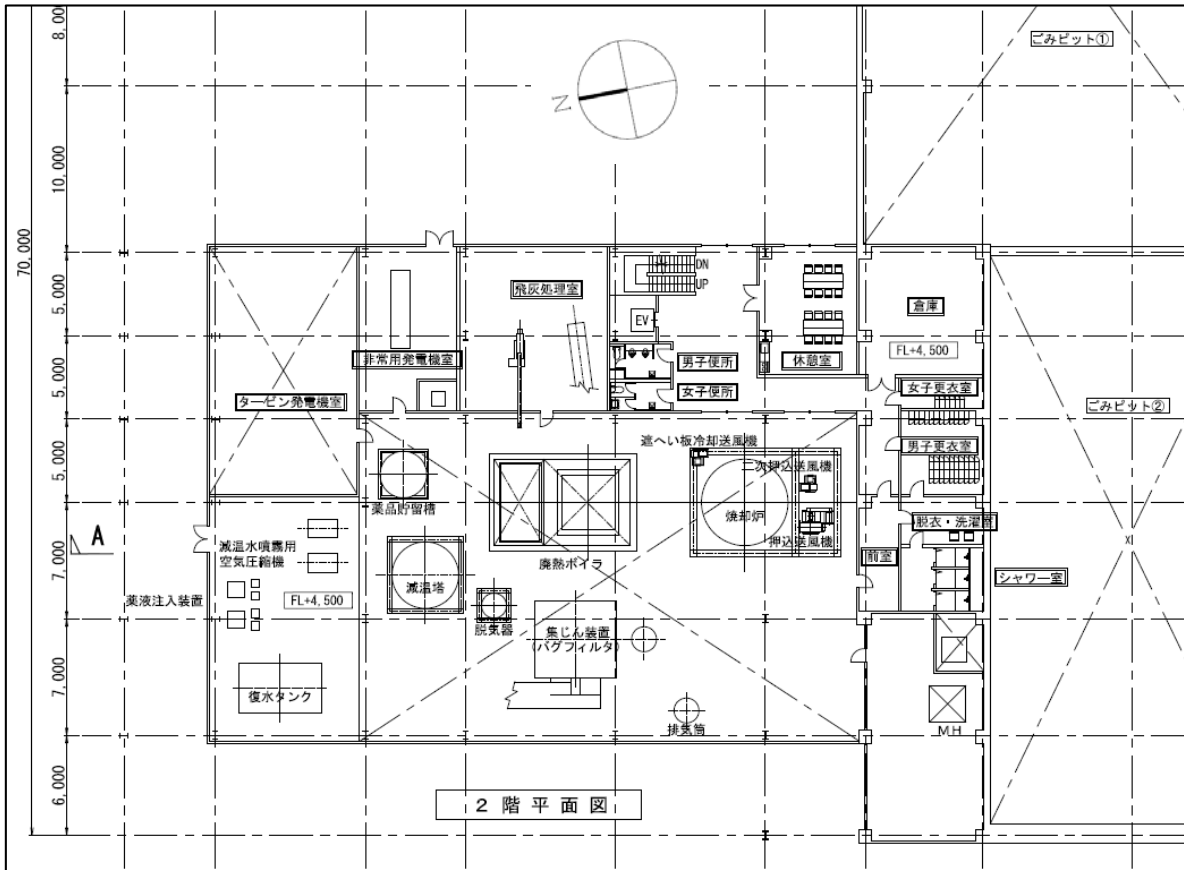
(2) 設備配置図 (焼却施設 2階)
